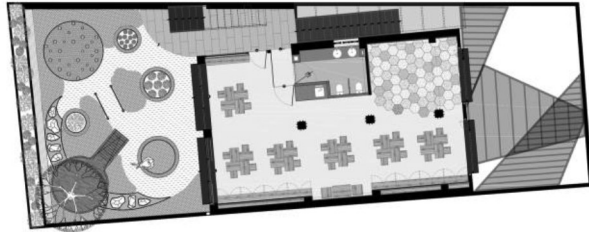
Planta do piso 1 da *Nía School* (Fonte: Archdaily)
